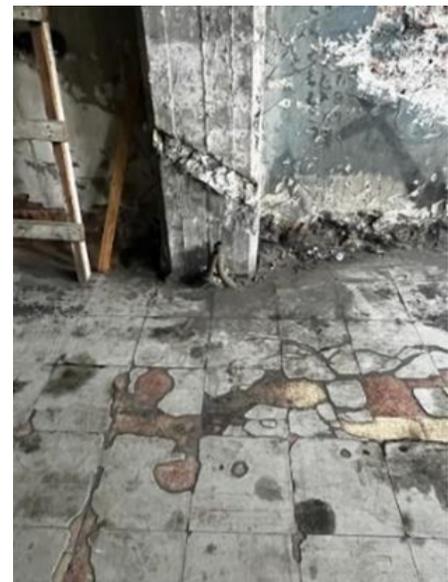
Piso vinílico sobre loseta cerámica en planta baja, abril 2022
